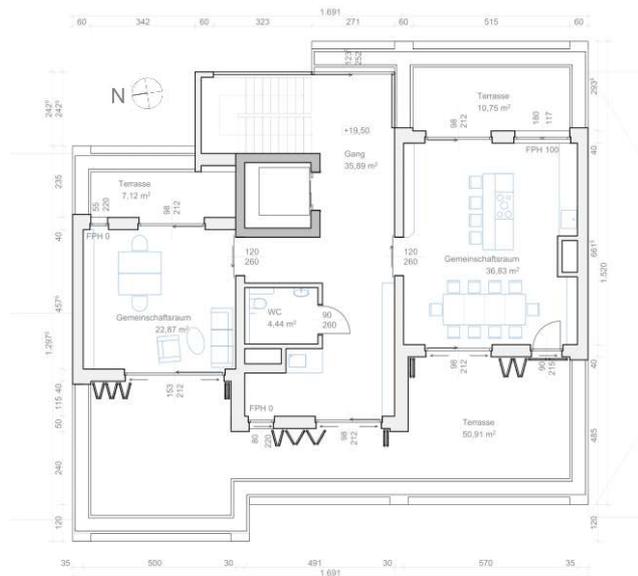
Grundriss Dachgeschoß (Quelle eigene Darstellung)
